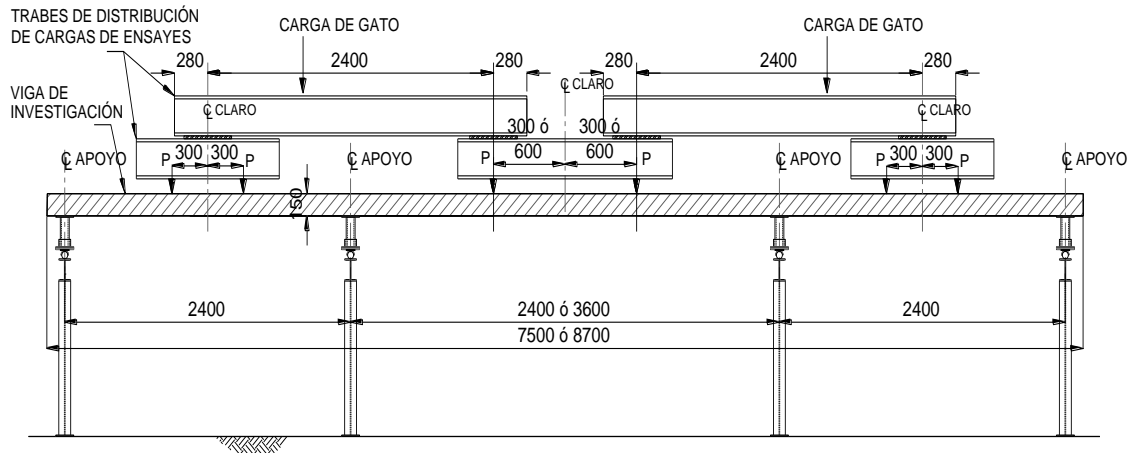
Esquema de aplicación de cargas en vigas continuas.
